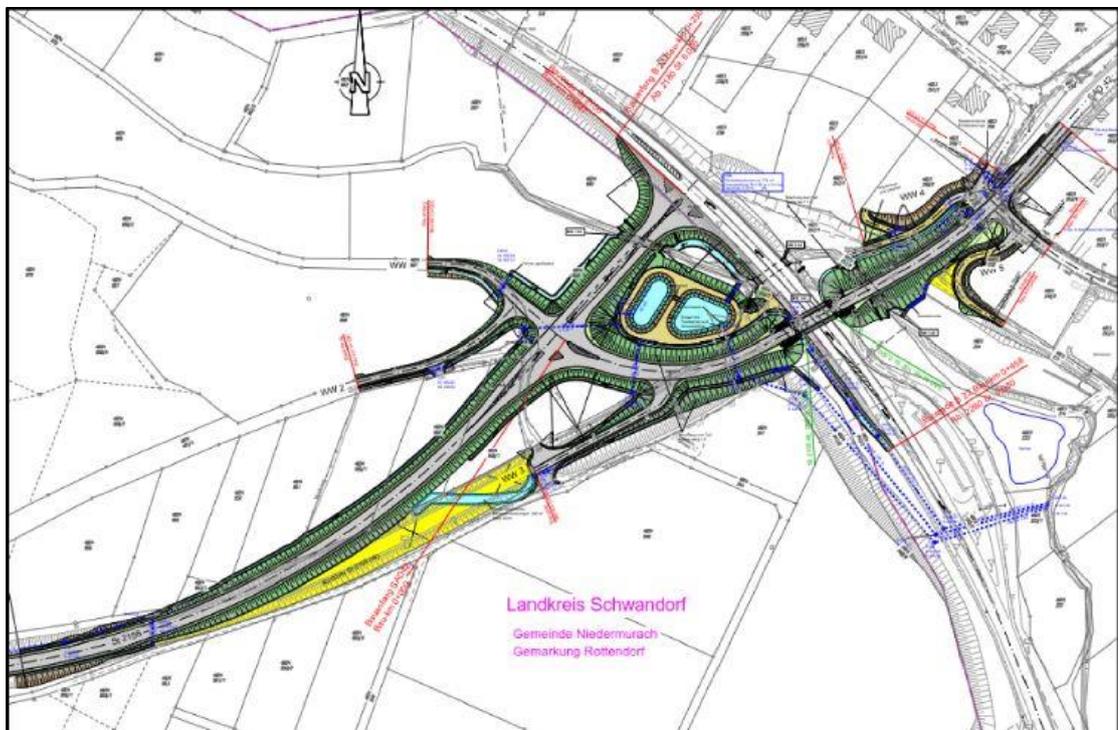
Umbau der Kreuzung der B22 mit der St 2156 und der Kreisstraße SAD 42 bei der Ortschaft Teunz (Landkreis Schwandorf, Regierungsbezirk Oberpfalz): Geplanter Trassenverlauf mit technischen Bauwerken Quelle: StBA Amberg-Sulzbach Fachbereich Straßenbau
